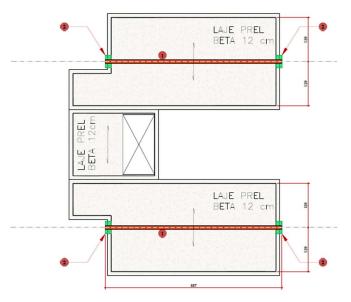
Implantação da área onde as vigas metálicas de reforço deverão ser instaladas.
